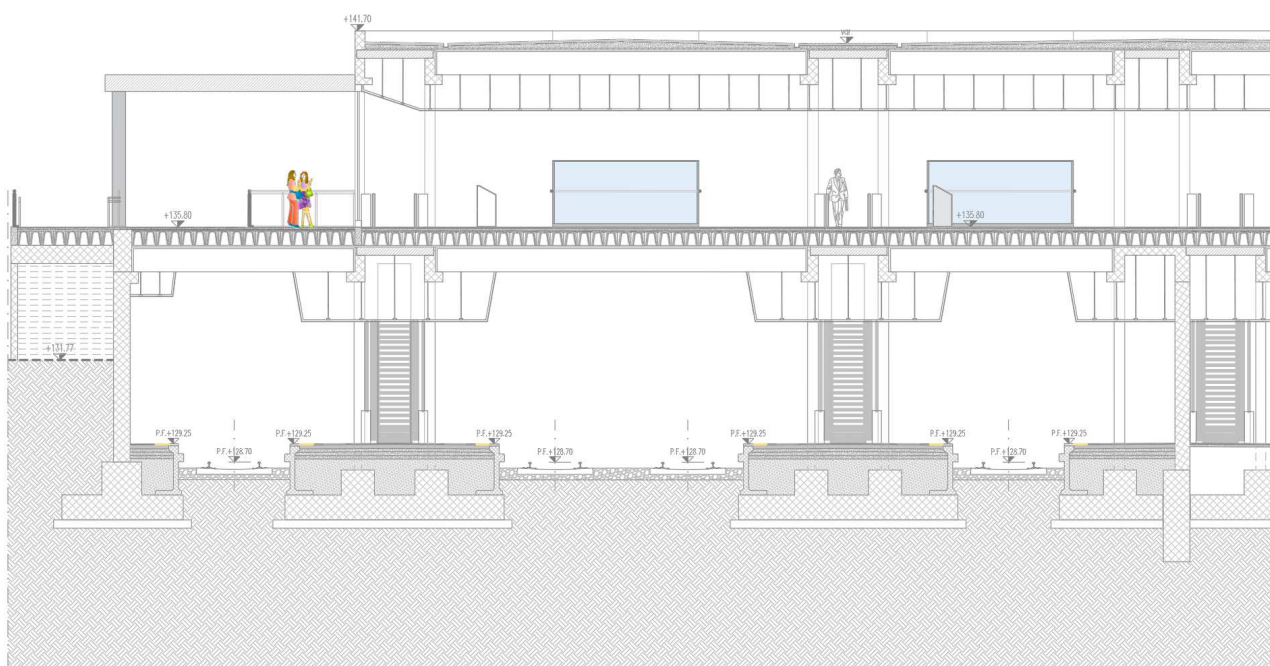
Sezione trasversale Piano Banchine nuovE.
